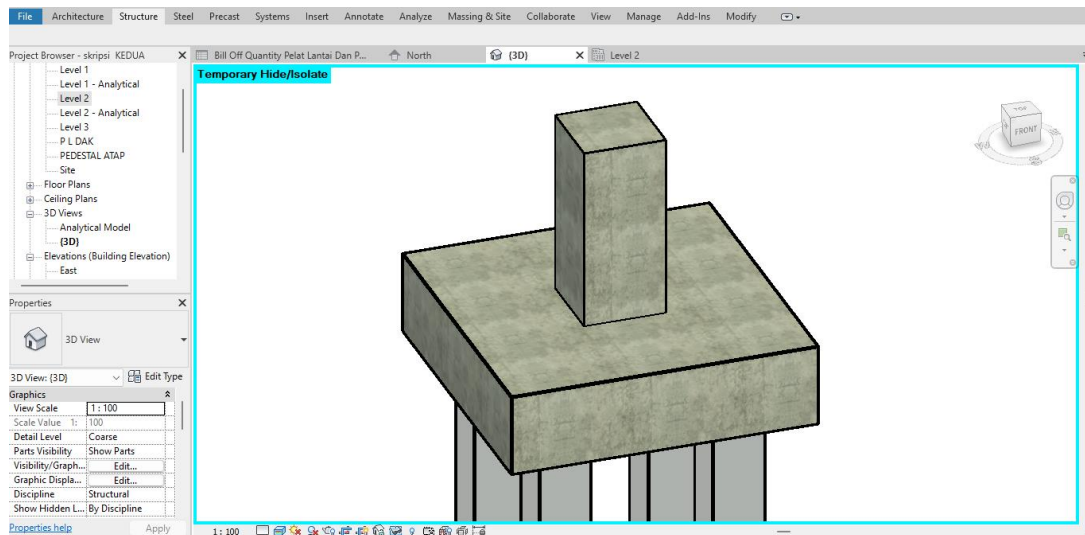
Tampilan Memasukkan Struktur Pondasi Tiang Pancang Ke Dalam Permodelan
